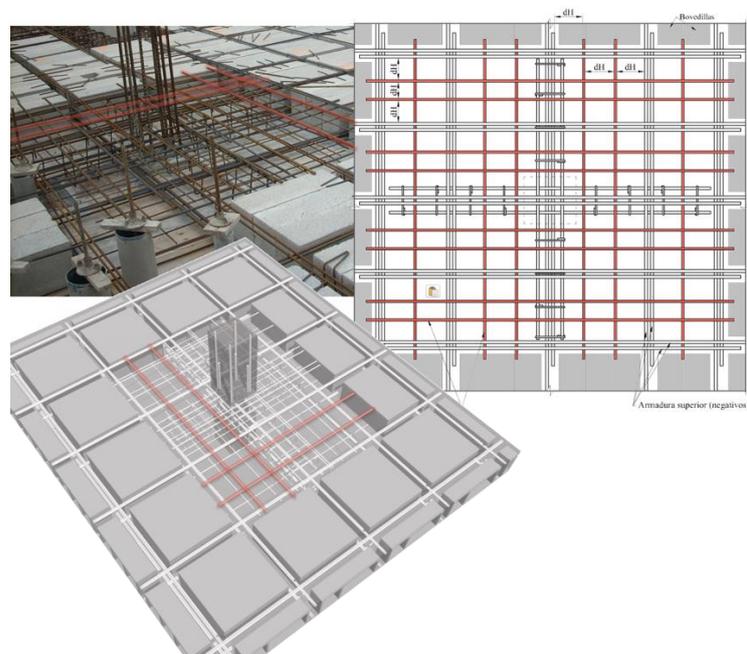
Armadura de montaje de ábacos (dos barras por casetón superior e inferiormente)
